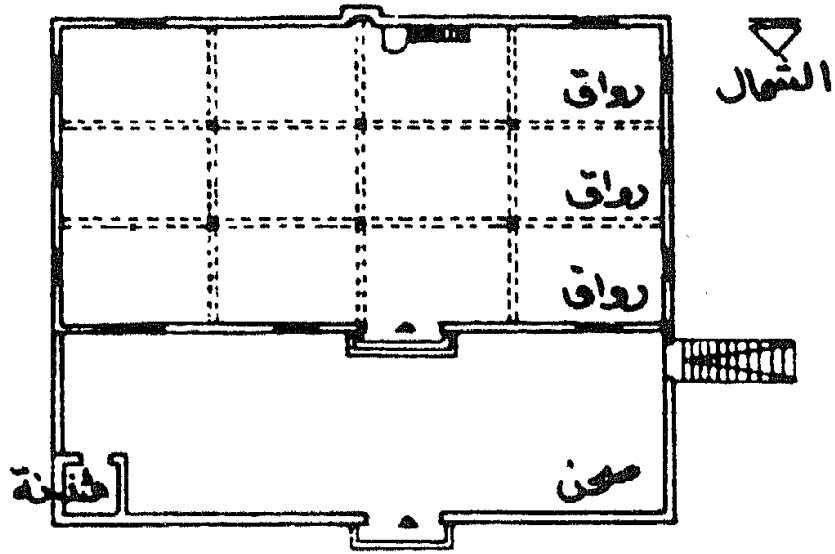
مسقط أفقى لمسجد الغمامة بالمدينة المنورة .
